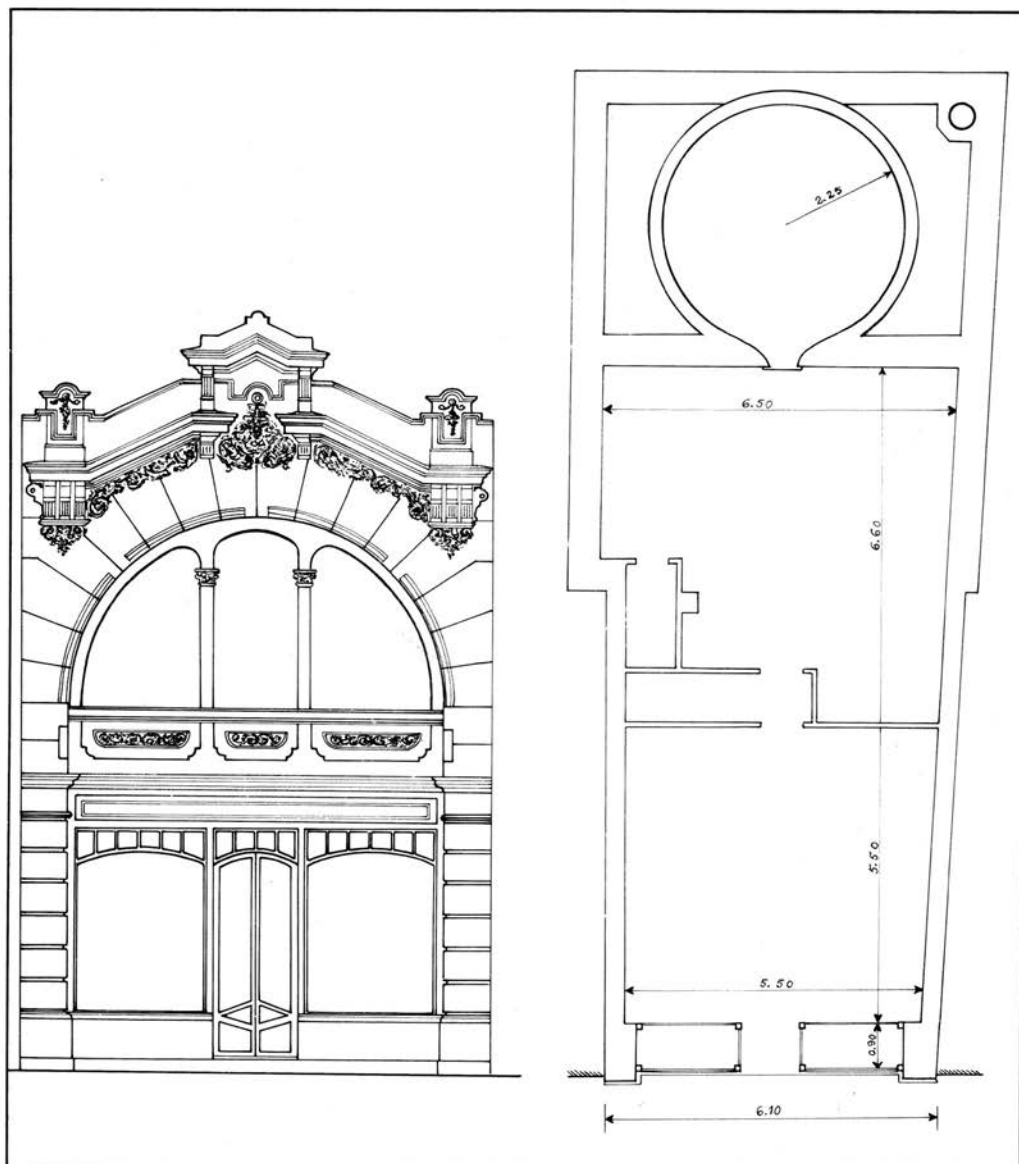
Pormenor da fachada (Rua Augusto Cardoso) e planta de uma padaria cujo projecto foi apresentado em 31/12/22 por Alberto Carmona.
